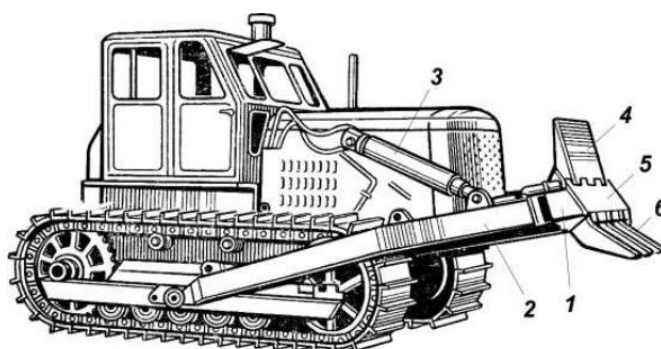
Схема корчевателя ДП-25 (Д-513А):
